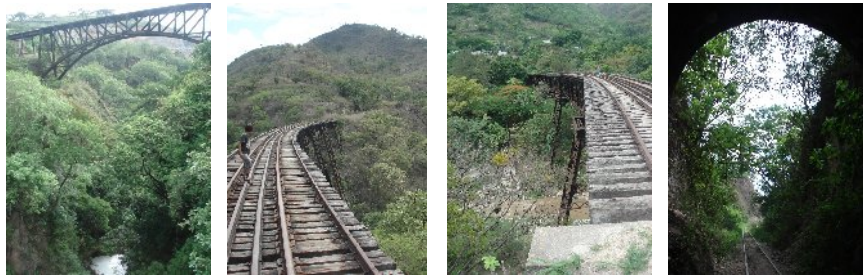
, 6-20, 6-21, 6-22. En su orden: Puente El Fiscal, puente El Tecolote, puente El Zopilote, túnel El Zopilote. Fuente: Visita de campo.
